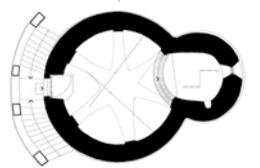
Grundriss OG, Haberl 1981. M 1:400.
